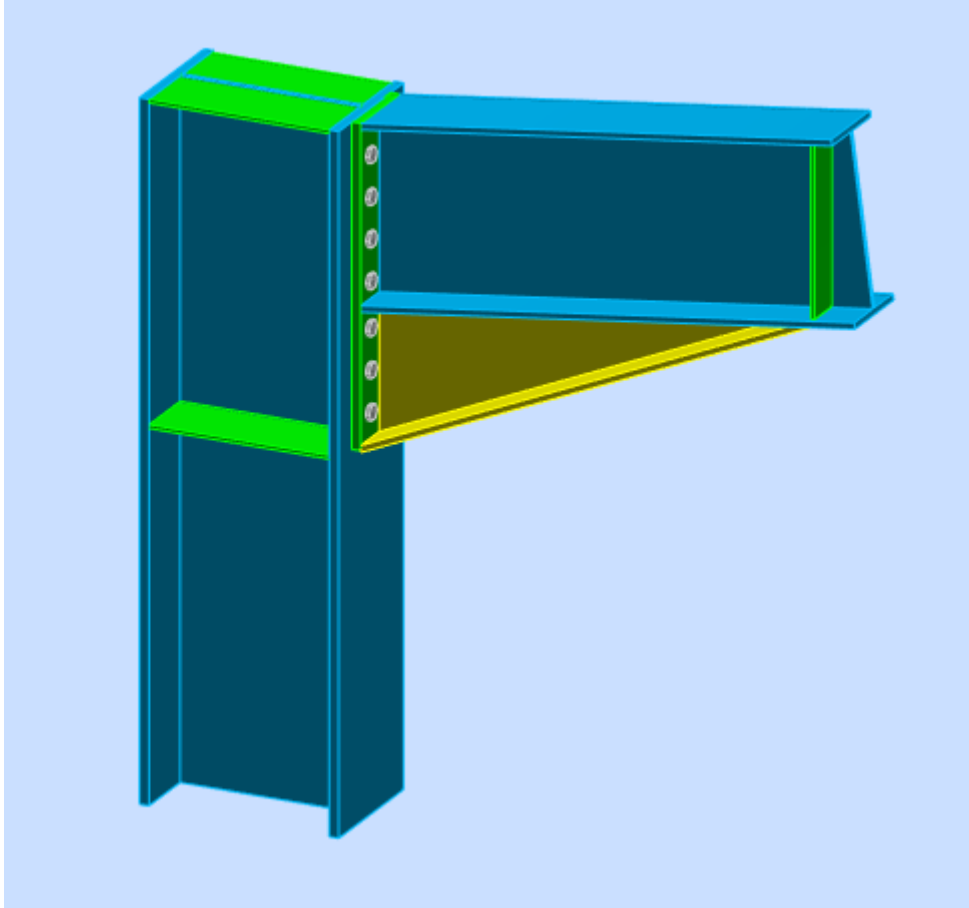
Vue d'assemblage poteau – traverse. [6]
